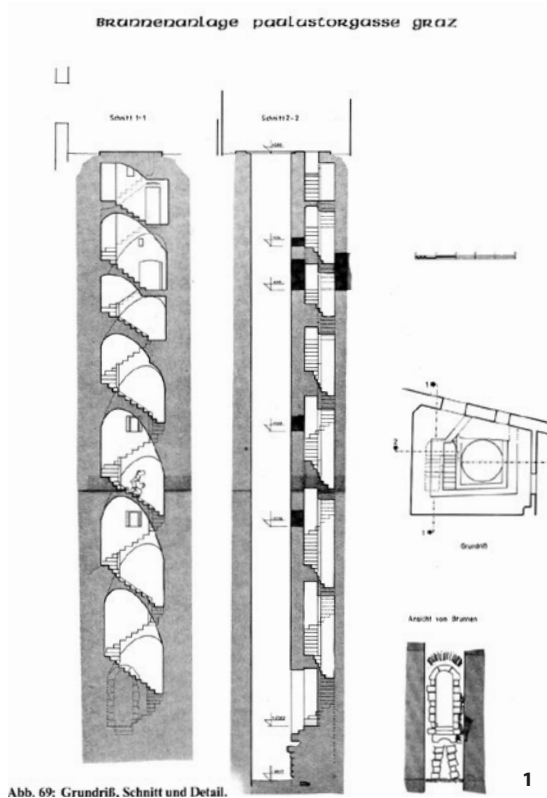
Grundriss, Schnitt und Detail.
